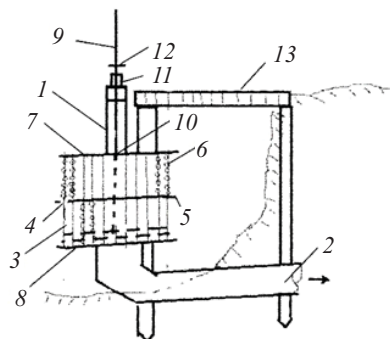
Водоприемный оголовок [15]: 1 — рама с подъемным механизмом; 2 — водозаборная труба; 3 — решетка; 4 — отверстия; 5 — кольцо; 6 — шарики; 7 — верхняя крышка; 8 — плита оголовка; 9 — штанга с винтовой нарезкой; 10 — узел крепления; 11 — гайка; 12 — колесо вращения; 13 — береговой мостик
